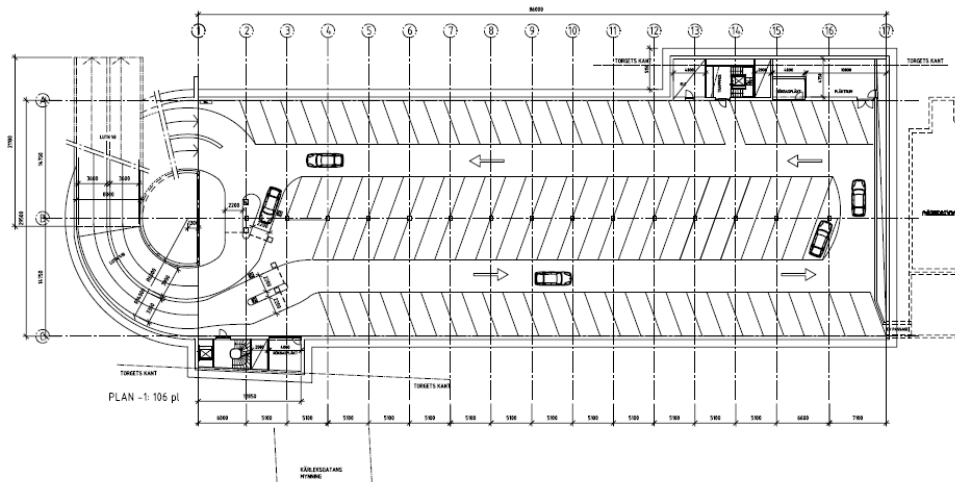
Utformningsförslag plan -1 enligt detaljplan 4866.
